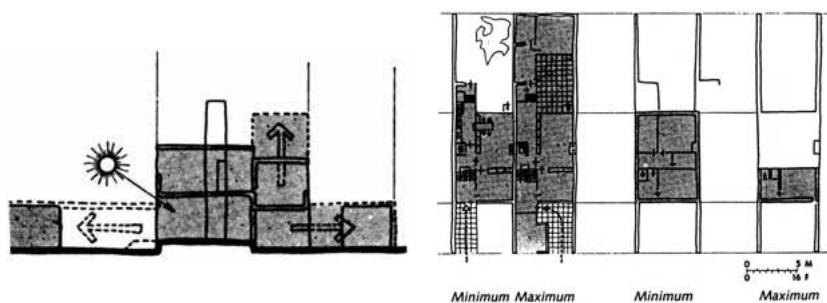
Casas expansíveis de 1963, Van Broek and Bakema_ Planta (Till, Wigglesworth e Schneider)
